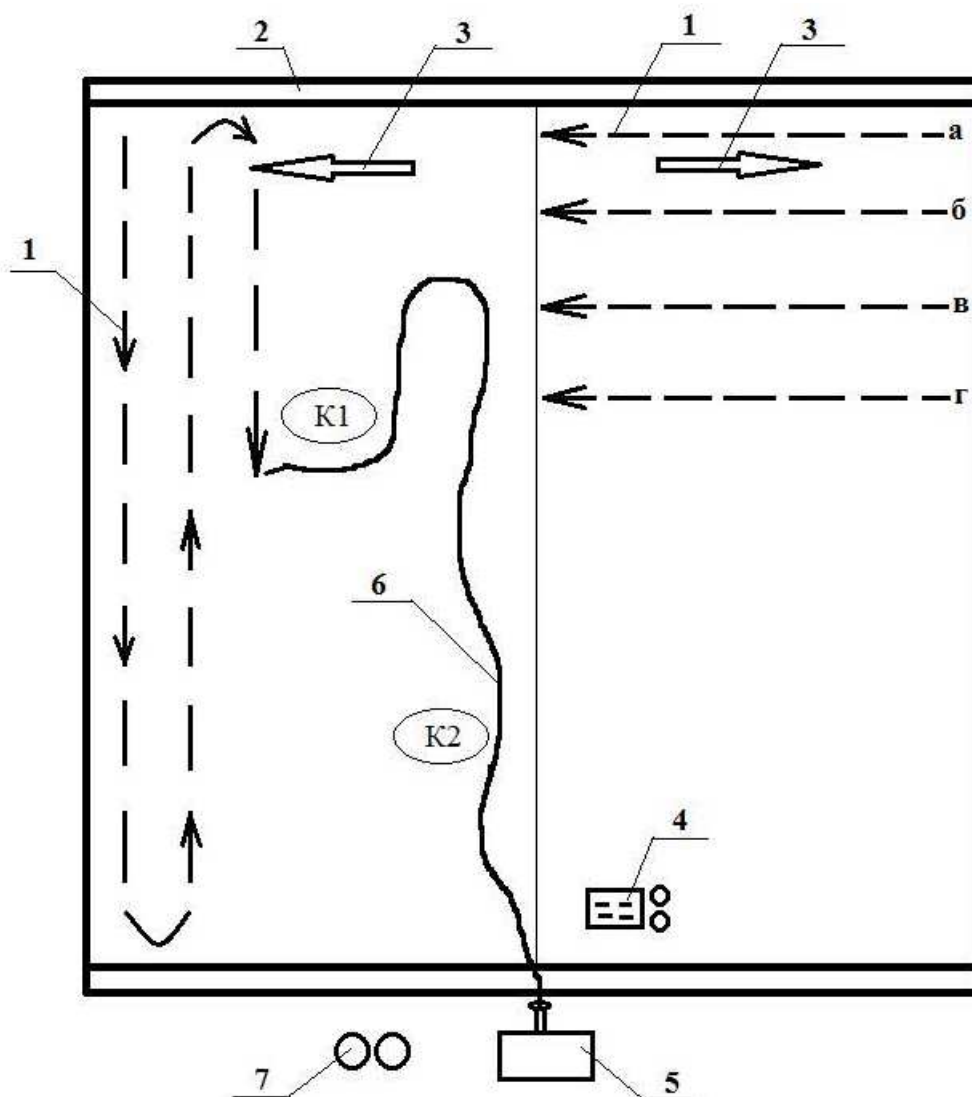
Схема организации рабочего места при устройстве кровли из жидкой резины «CBS кровельная», размещение установки возле здания:
